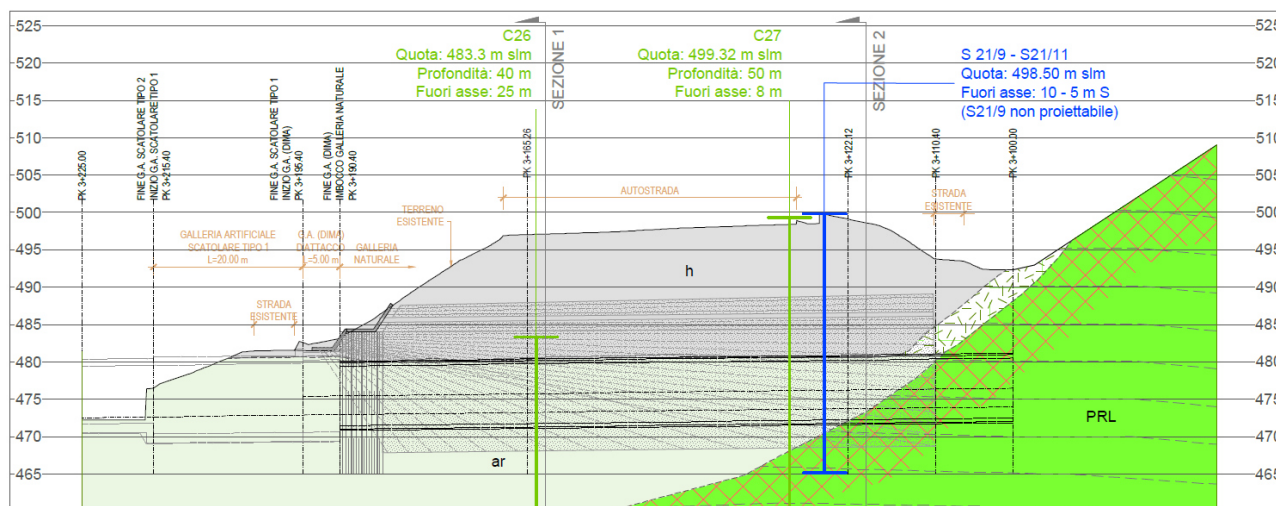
Stralcio del planoprofilo di dettaglio dell'imbocco dell'interconnessione di Ponte Gardena – binario dispari con la sezione longitudinale lungo il tracciato nel tratto di sottopasso del rilevato dell'autostrada A22- elaborato IBOU1BEZZL7GE0001006B.
